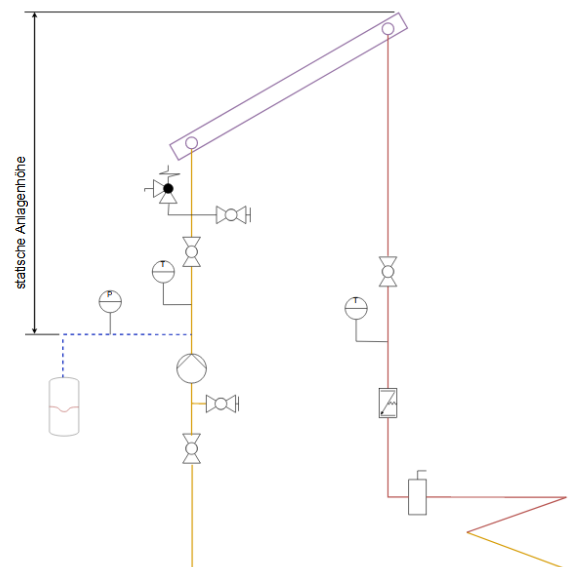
Druckseitige Einbindung des Expansionsgefäss
